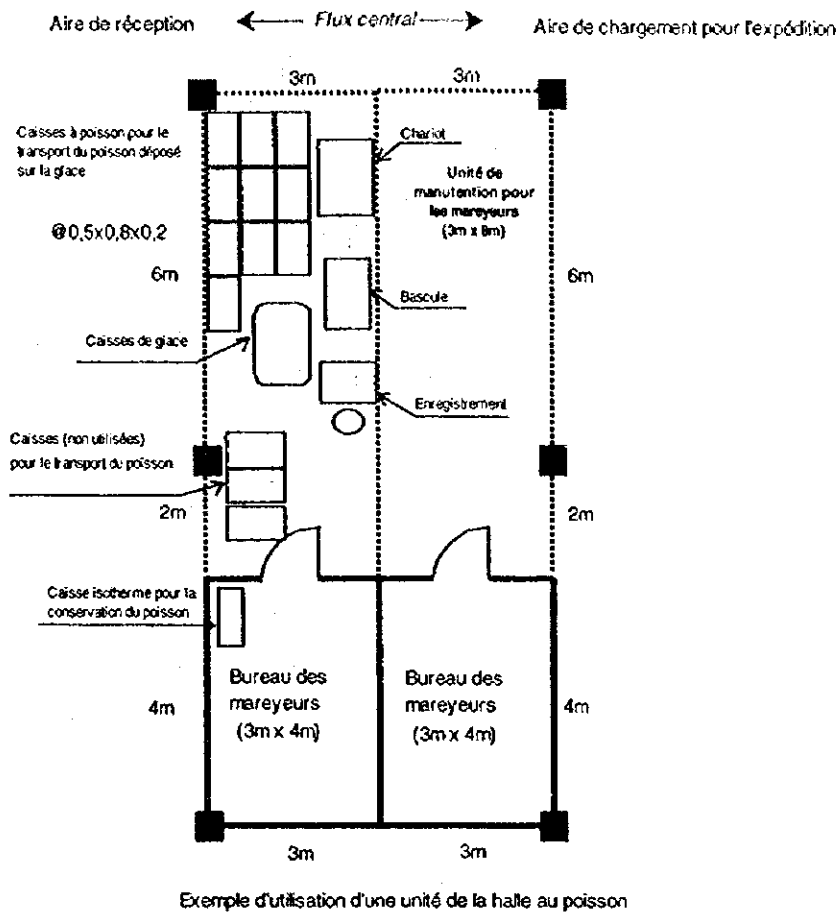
Plan d'utilisation de la halle au poisson
